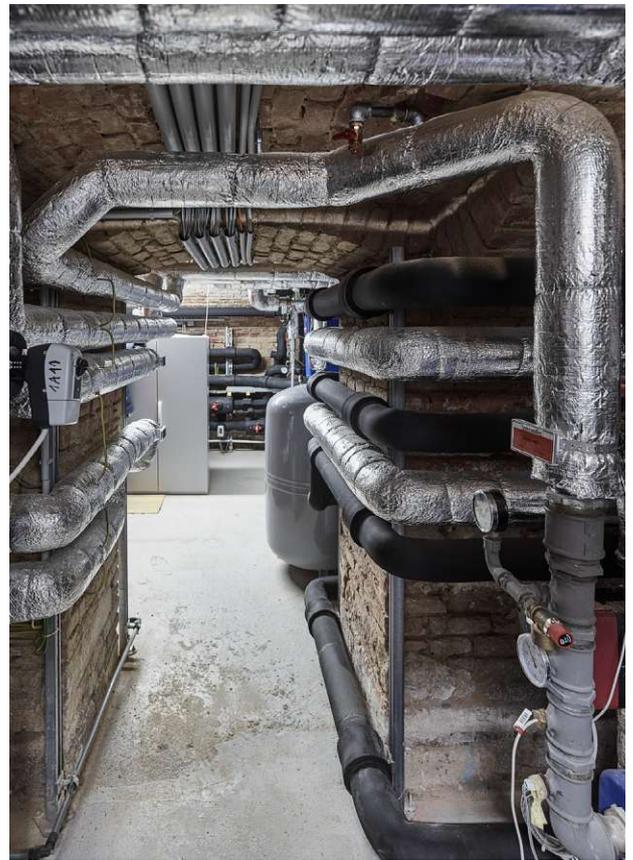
Verlegte Haustechnikleitungen im Kellergeschoss (architektur.hoerbst.com/projekt/wohngebäude-geblergasse/)
